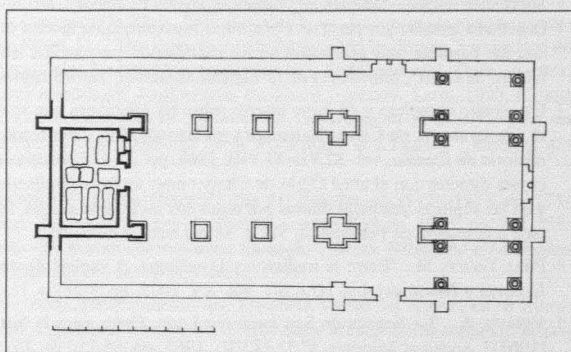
Planta de Santa María de Oviedo (según I.G. Bango Torviso).
